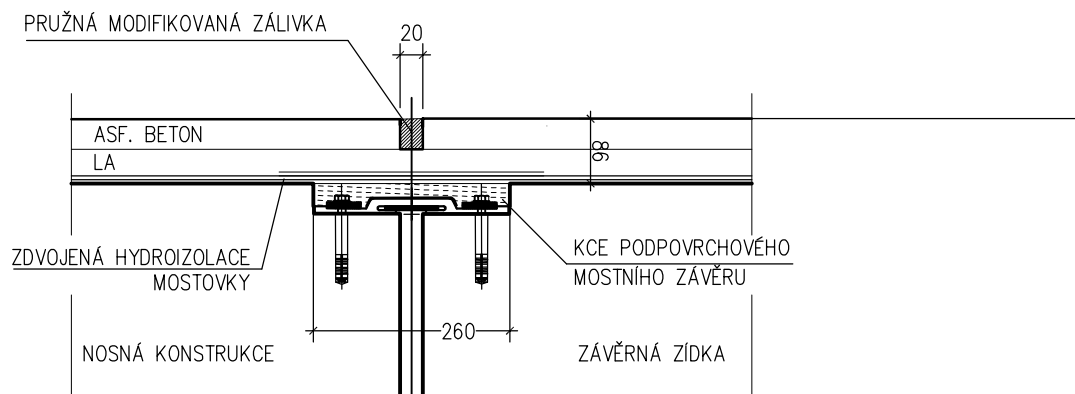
# DETAIL PODPOVRCHOVÉHO ZÁVĚRU 1:10
